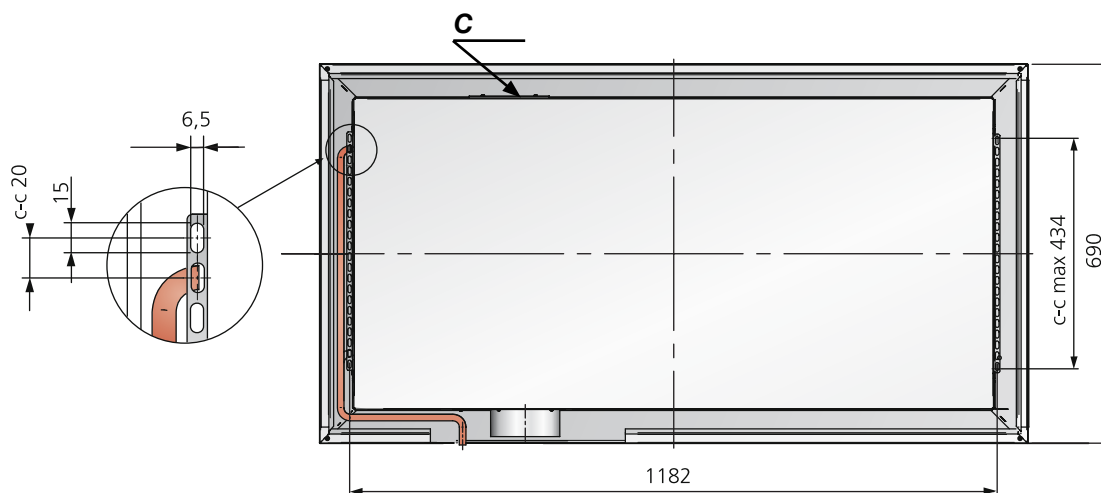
Parasol EX 690 с креплением, вид сверху
